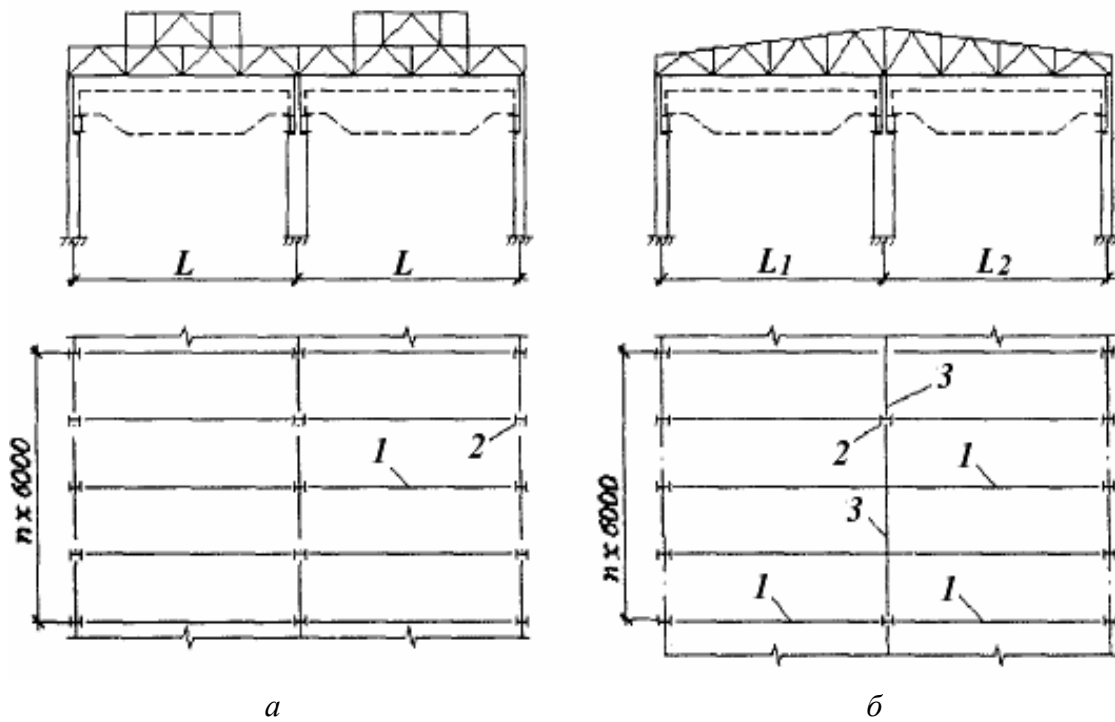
Конструктивні схеми багатопрольотних каркасів: *а* – крок колон зовнішніх і внутрішніх рядів однаковий; *б* – крок колон зовнішніх і внутрішніх рядів різний; 1 – кроквяні ферми, 2 – колони, 3 – підкроквяні ферми
